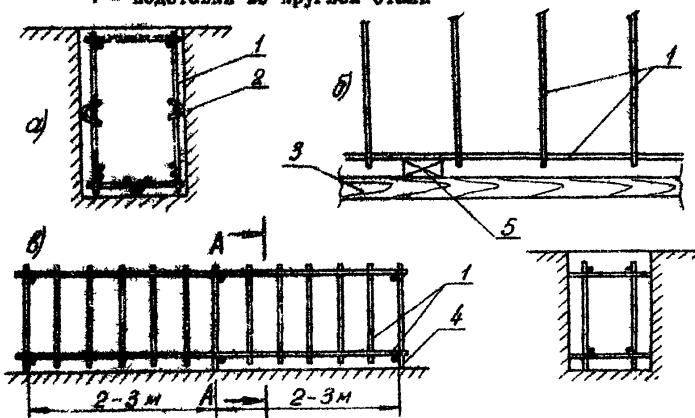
Способы обеспечения необходимого защитного слоя в железобетонных конструкциях
